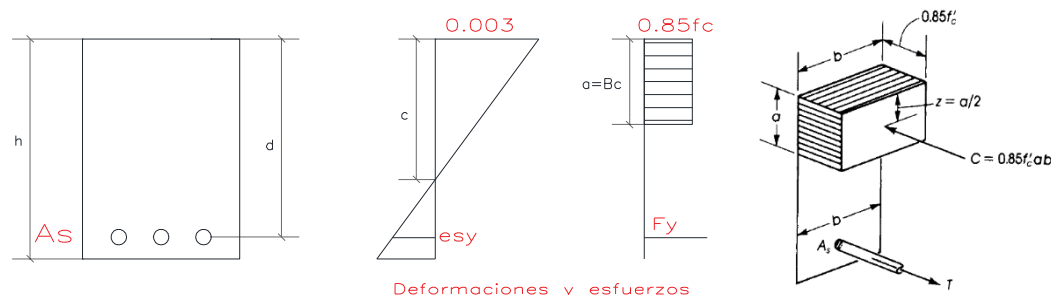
Diagrama de esfuerzos en sección rectangular de concreto
